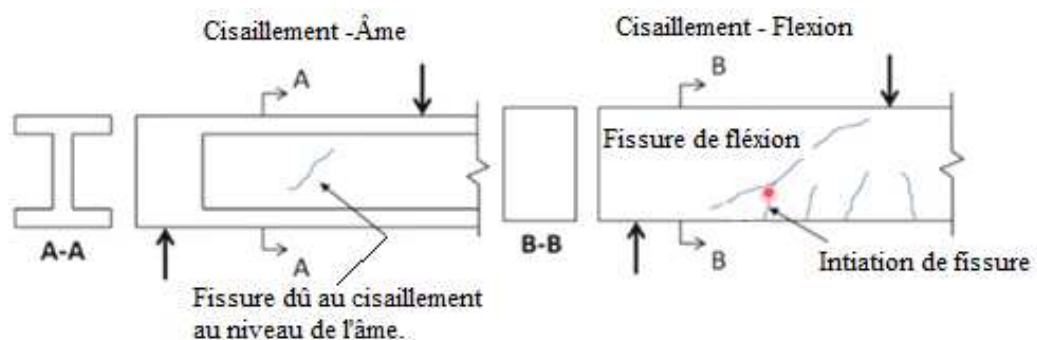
a)- Développement de fissure au niveau de l'âme ; Mode de rupture causé par l'écrasement du béton de l'âme [7]
